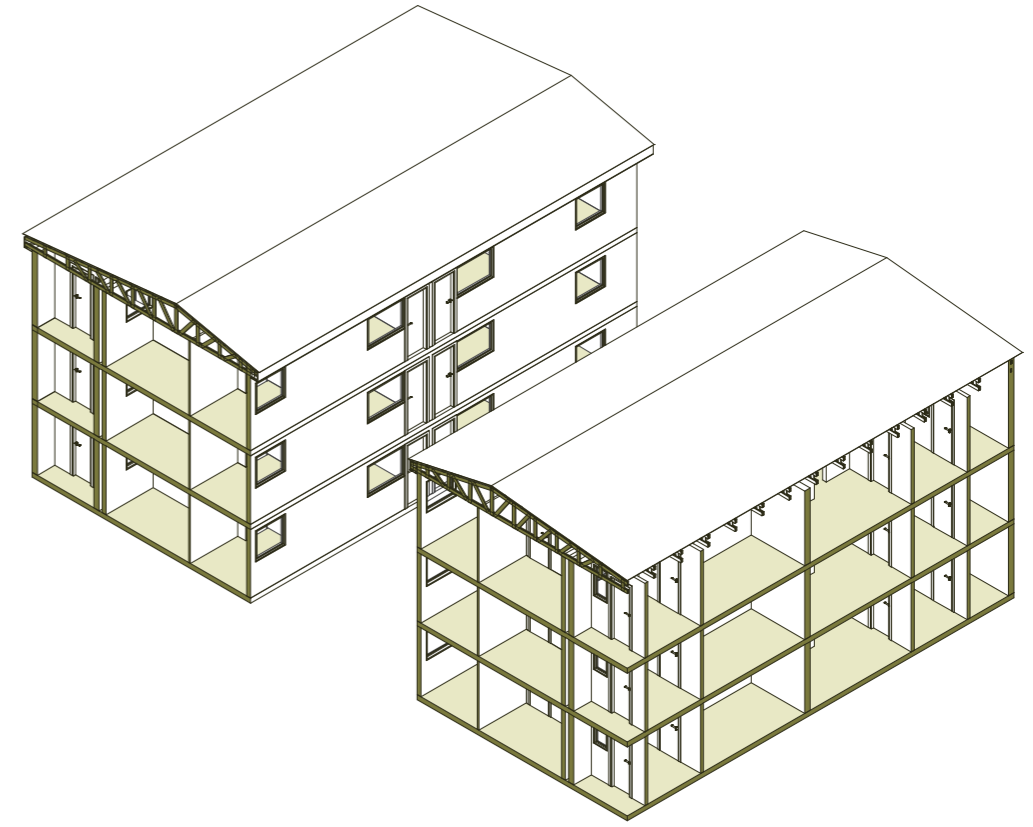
Isométrica y planta de proyecto con intervención PRCCS
